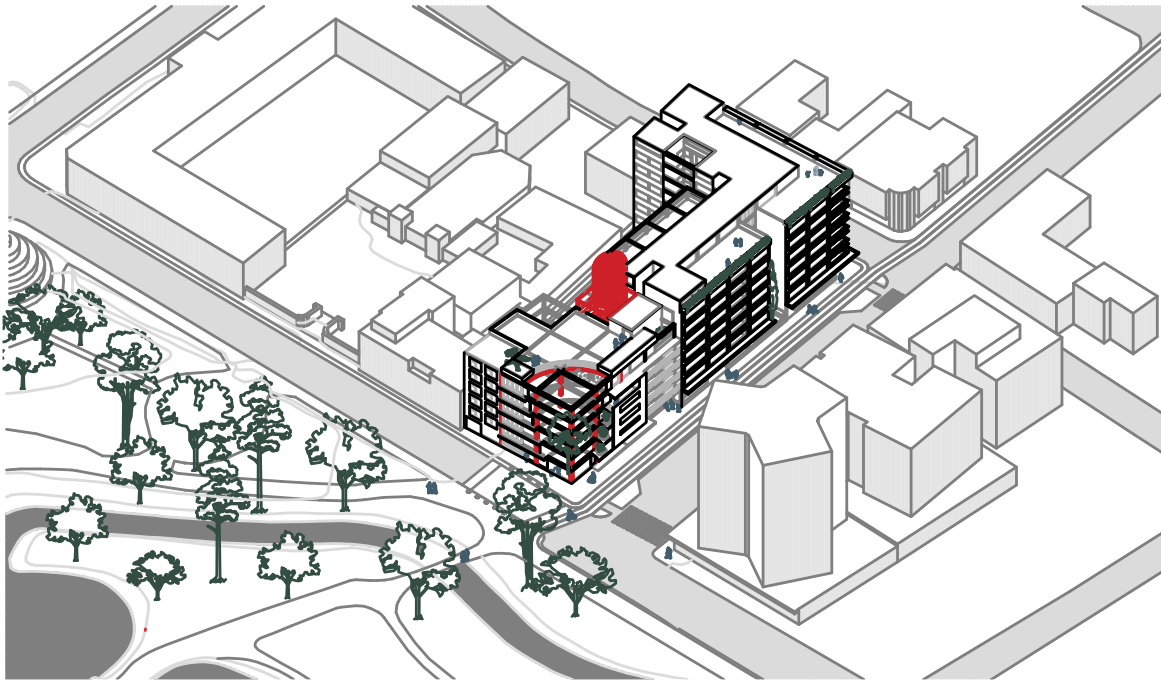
Isometría proyecto arquitectónico, 2024, Quito. Elaboración propia.
